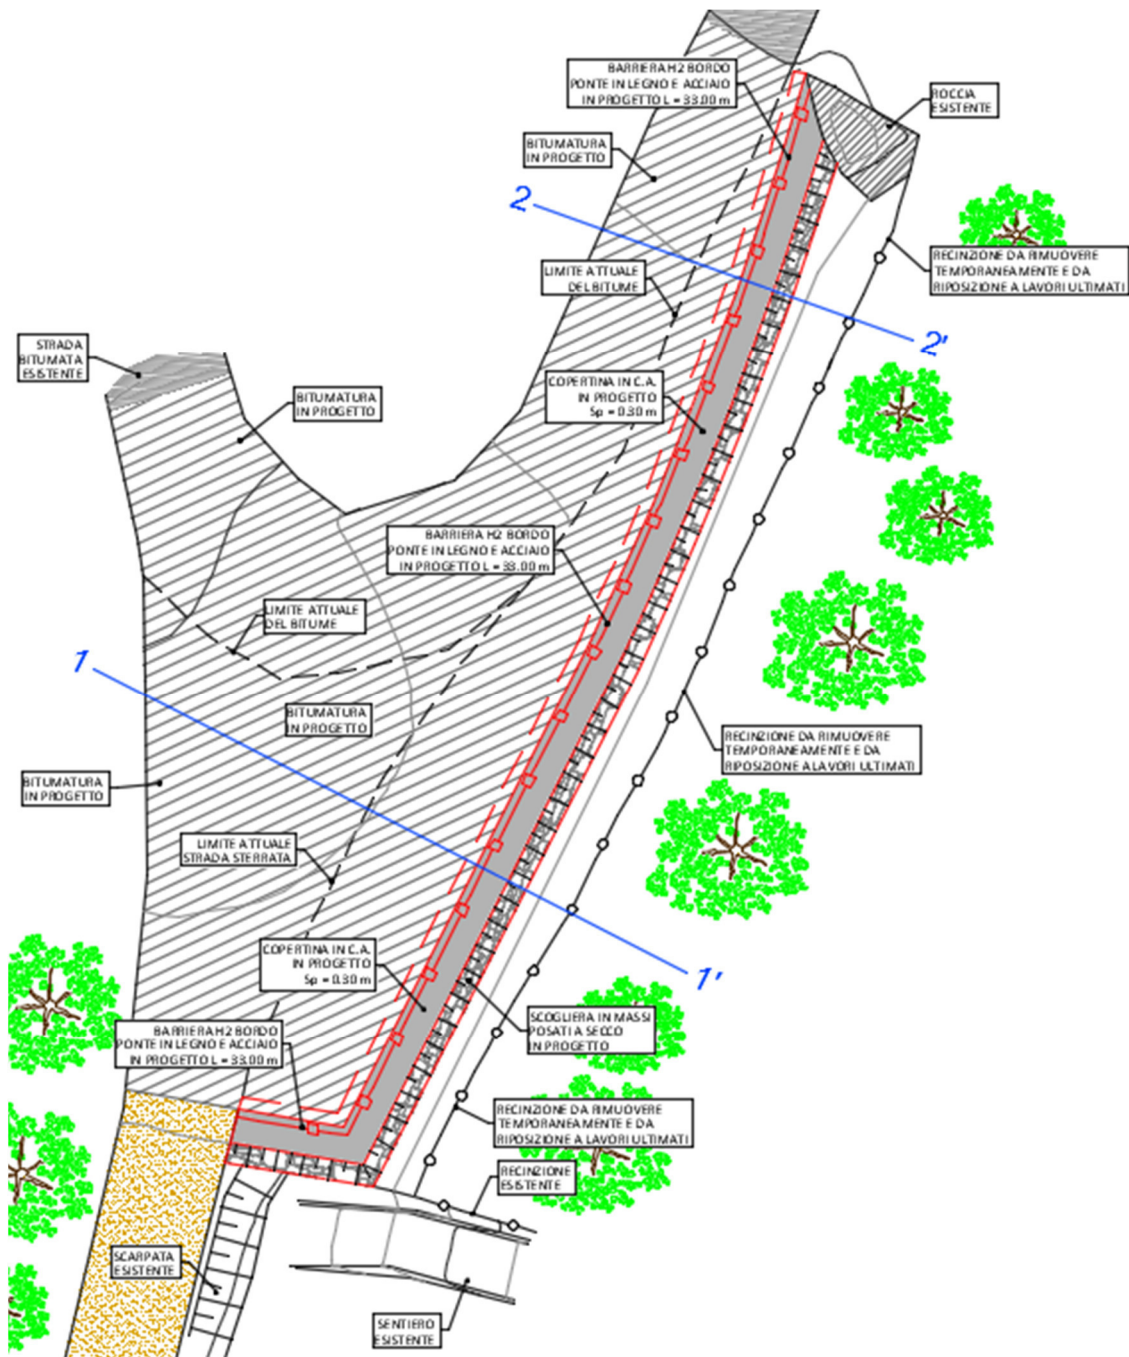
Estratto Tav.04B_Planimetria_progetto.
